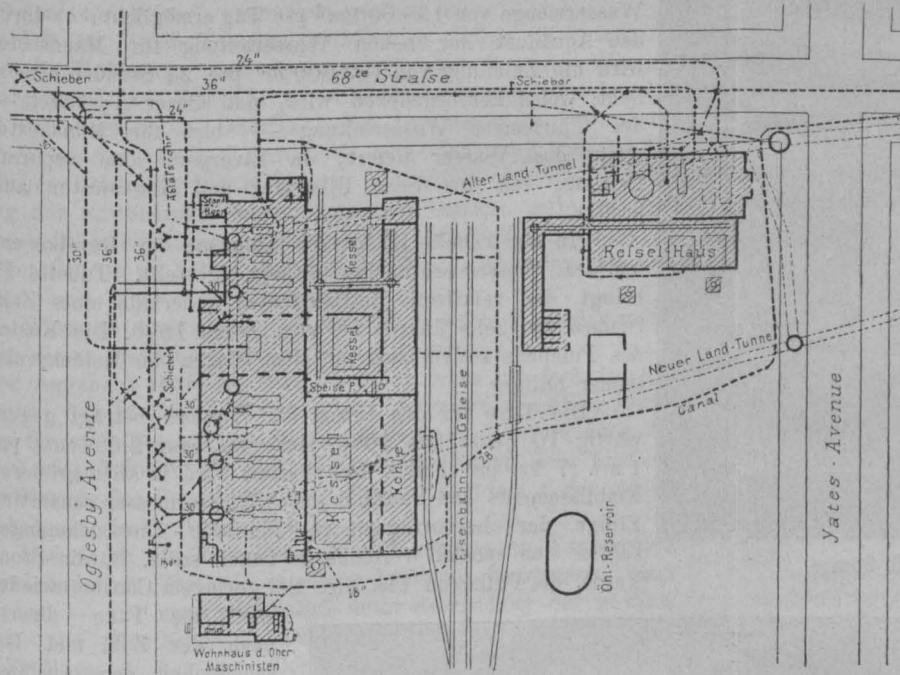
Grundriss der Pumpstation in der 68. Straße. 1:1500.
